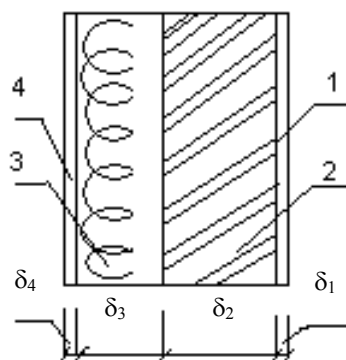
К примеру определения толщины утепляющего слоя наружной стены
